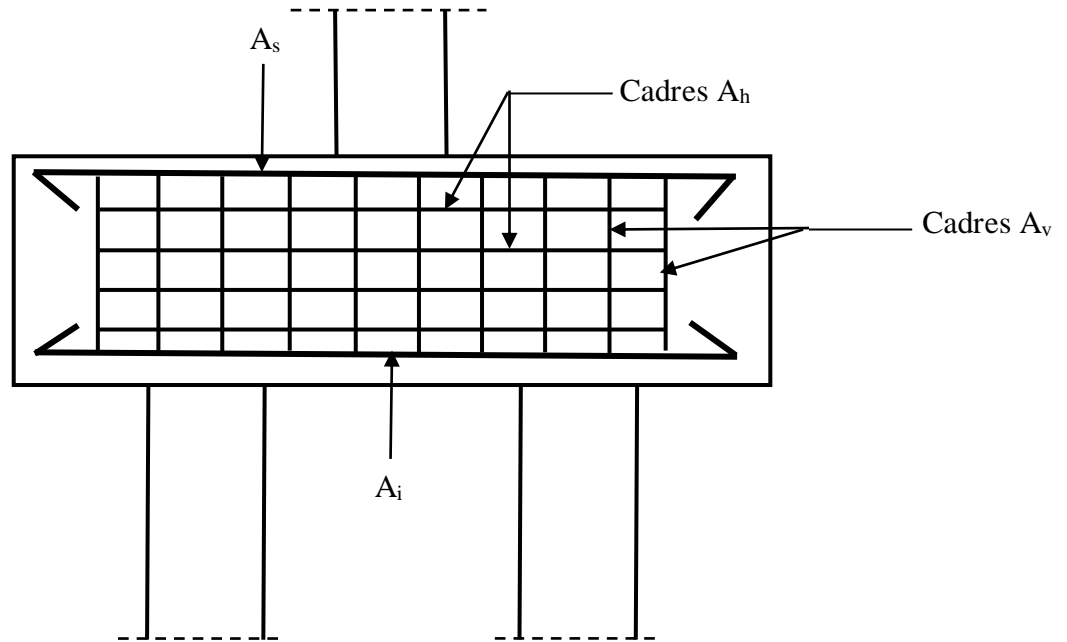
Ferrailage d'une semelle de fondation sur deux pieux.
